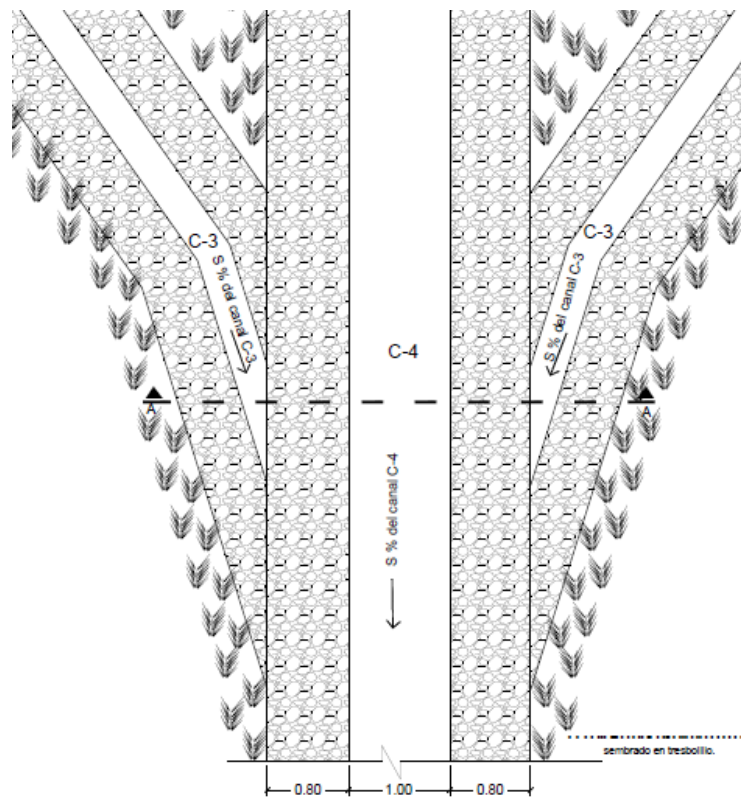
Detalle típico Empalme canales C-3 a C-4 (sin escala)
